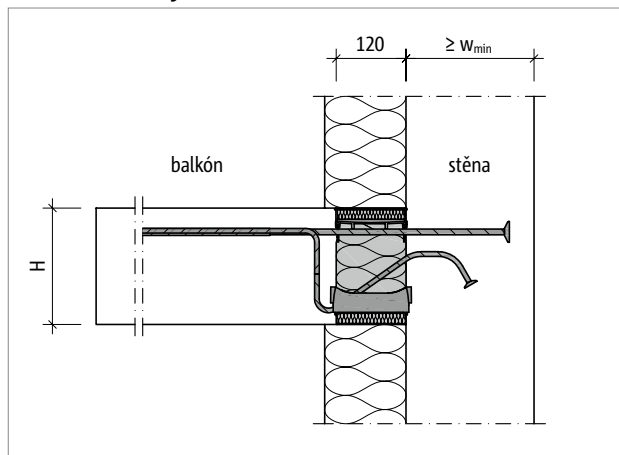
Schöck Isokorb® XT typ KL-U: Balkón snížený oproti stropní desce, vnější zateplení
